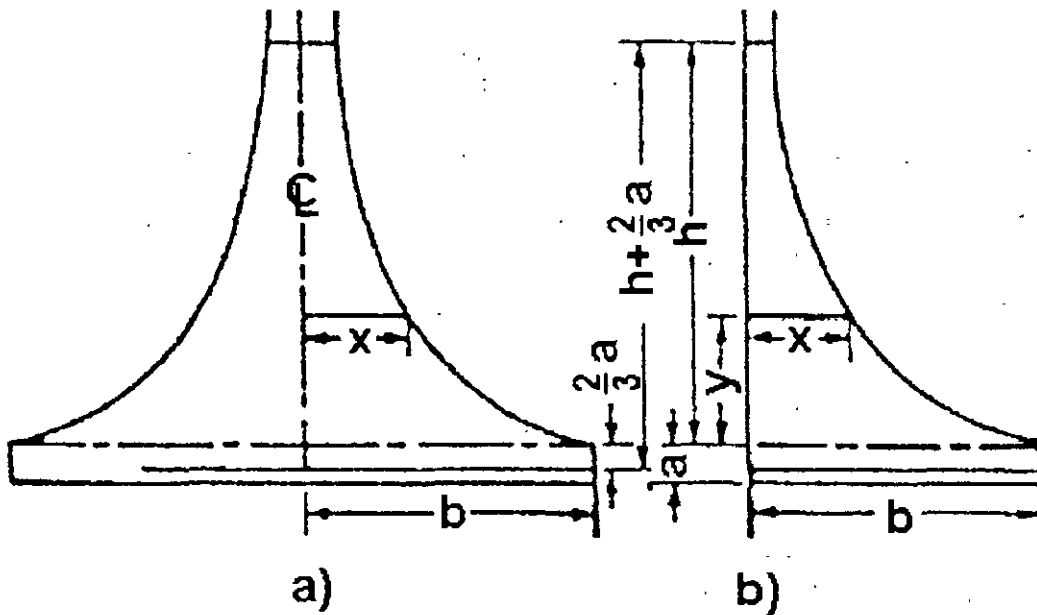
Elementos de un vertedor proporcional (a) y de un vertedor tipo sutro (b)
